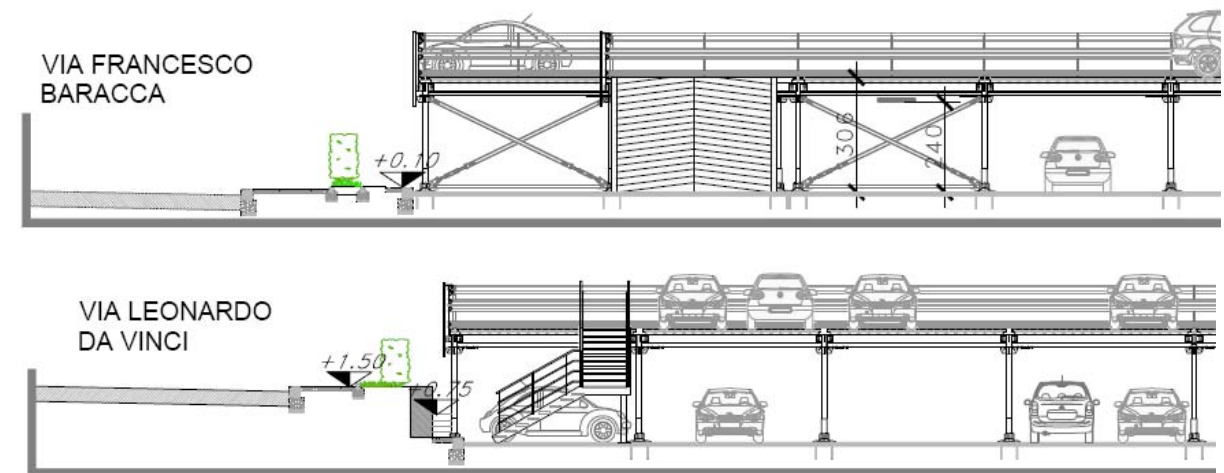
parcheggio multipiano modulare tipo fast park P5: dettagli sezione A-A' e sezione B-B'
